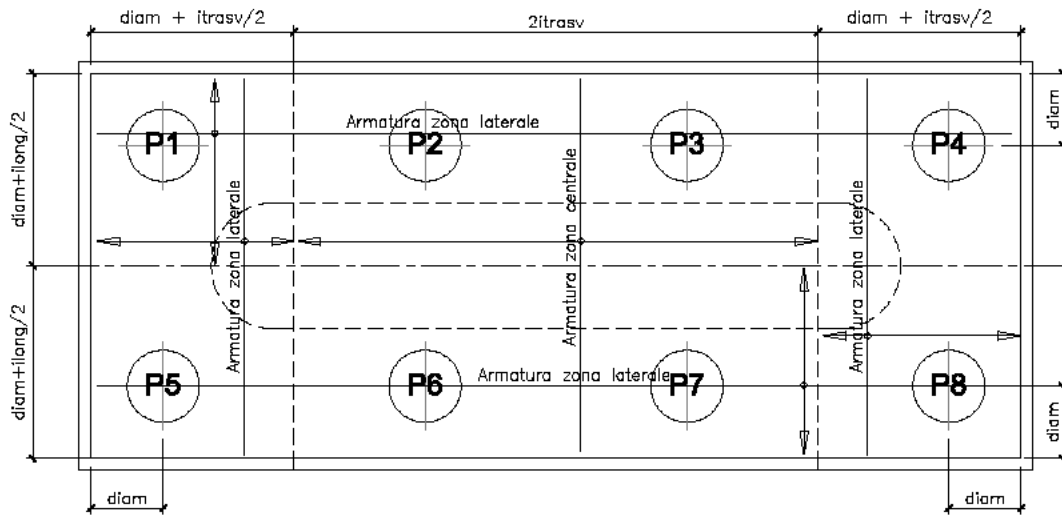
Plinto di fondazione – Armatura longitudinale inferiore e superiore
